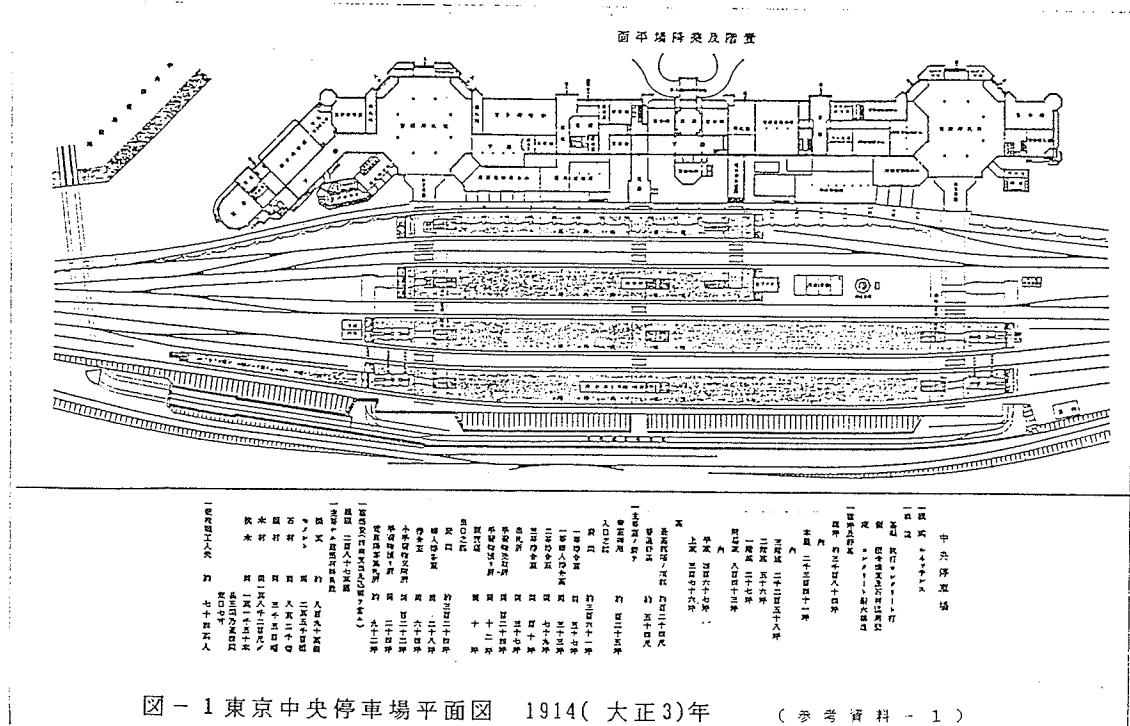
東京中央停車場平面図 1914(大正3年) (参考資料-1)
